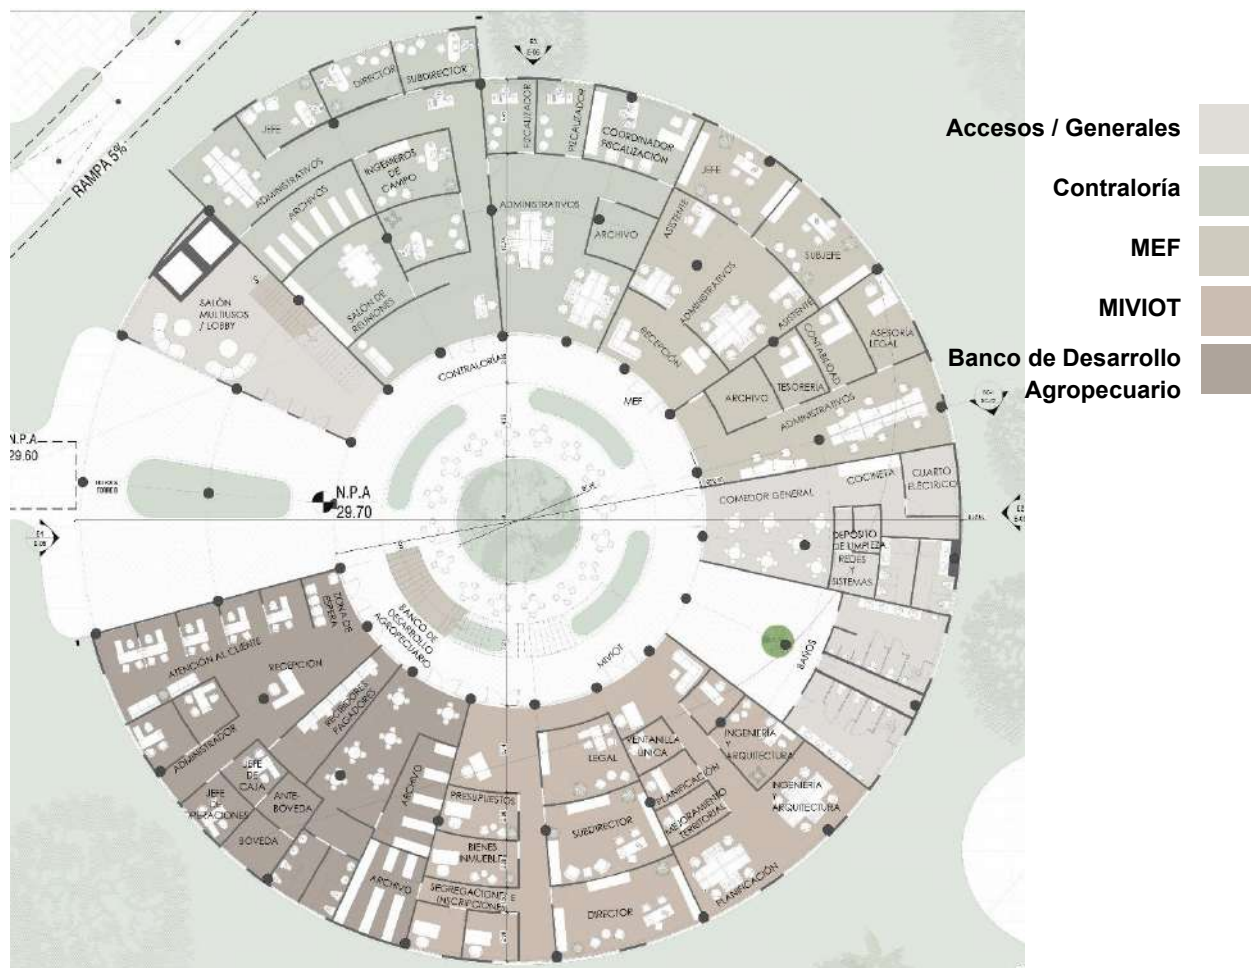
Ampliación de la planta baja de la torre B. Fuente: elaboración propia 2025
